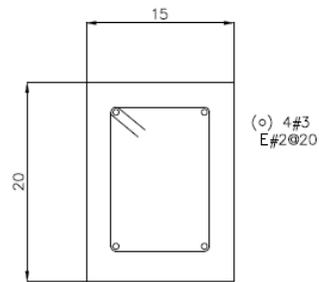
Detalle de sección de dalas inferiores tipo D-1
